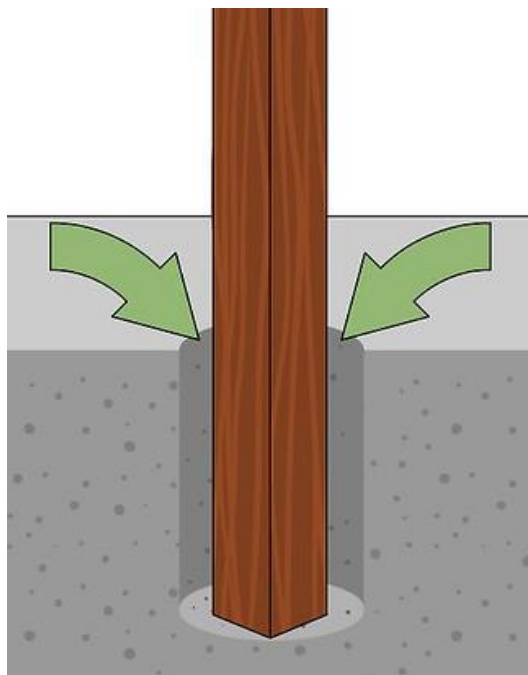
Elemento de madera empotrado en hormigón (Wikihow, 2015)
